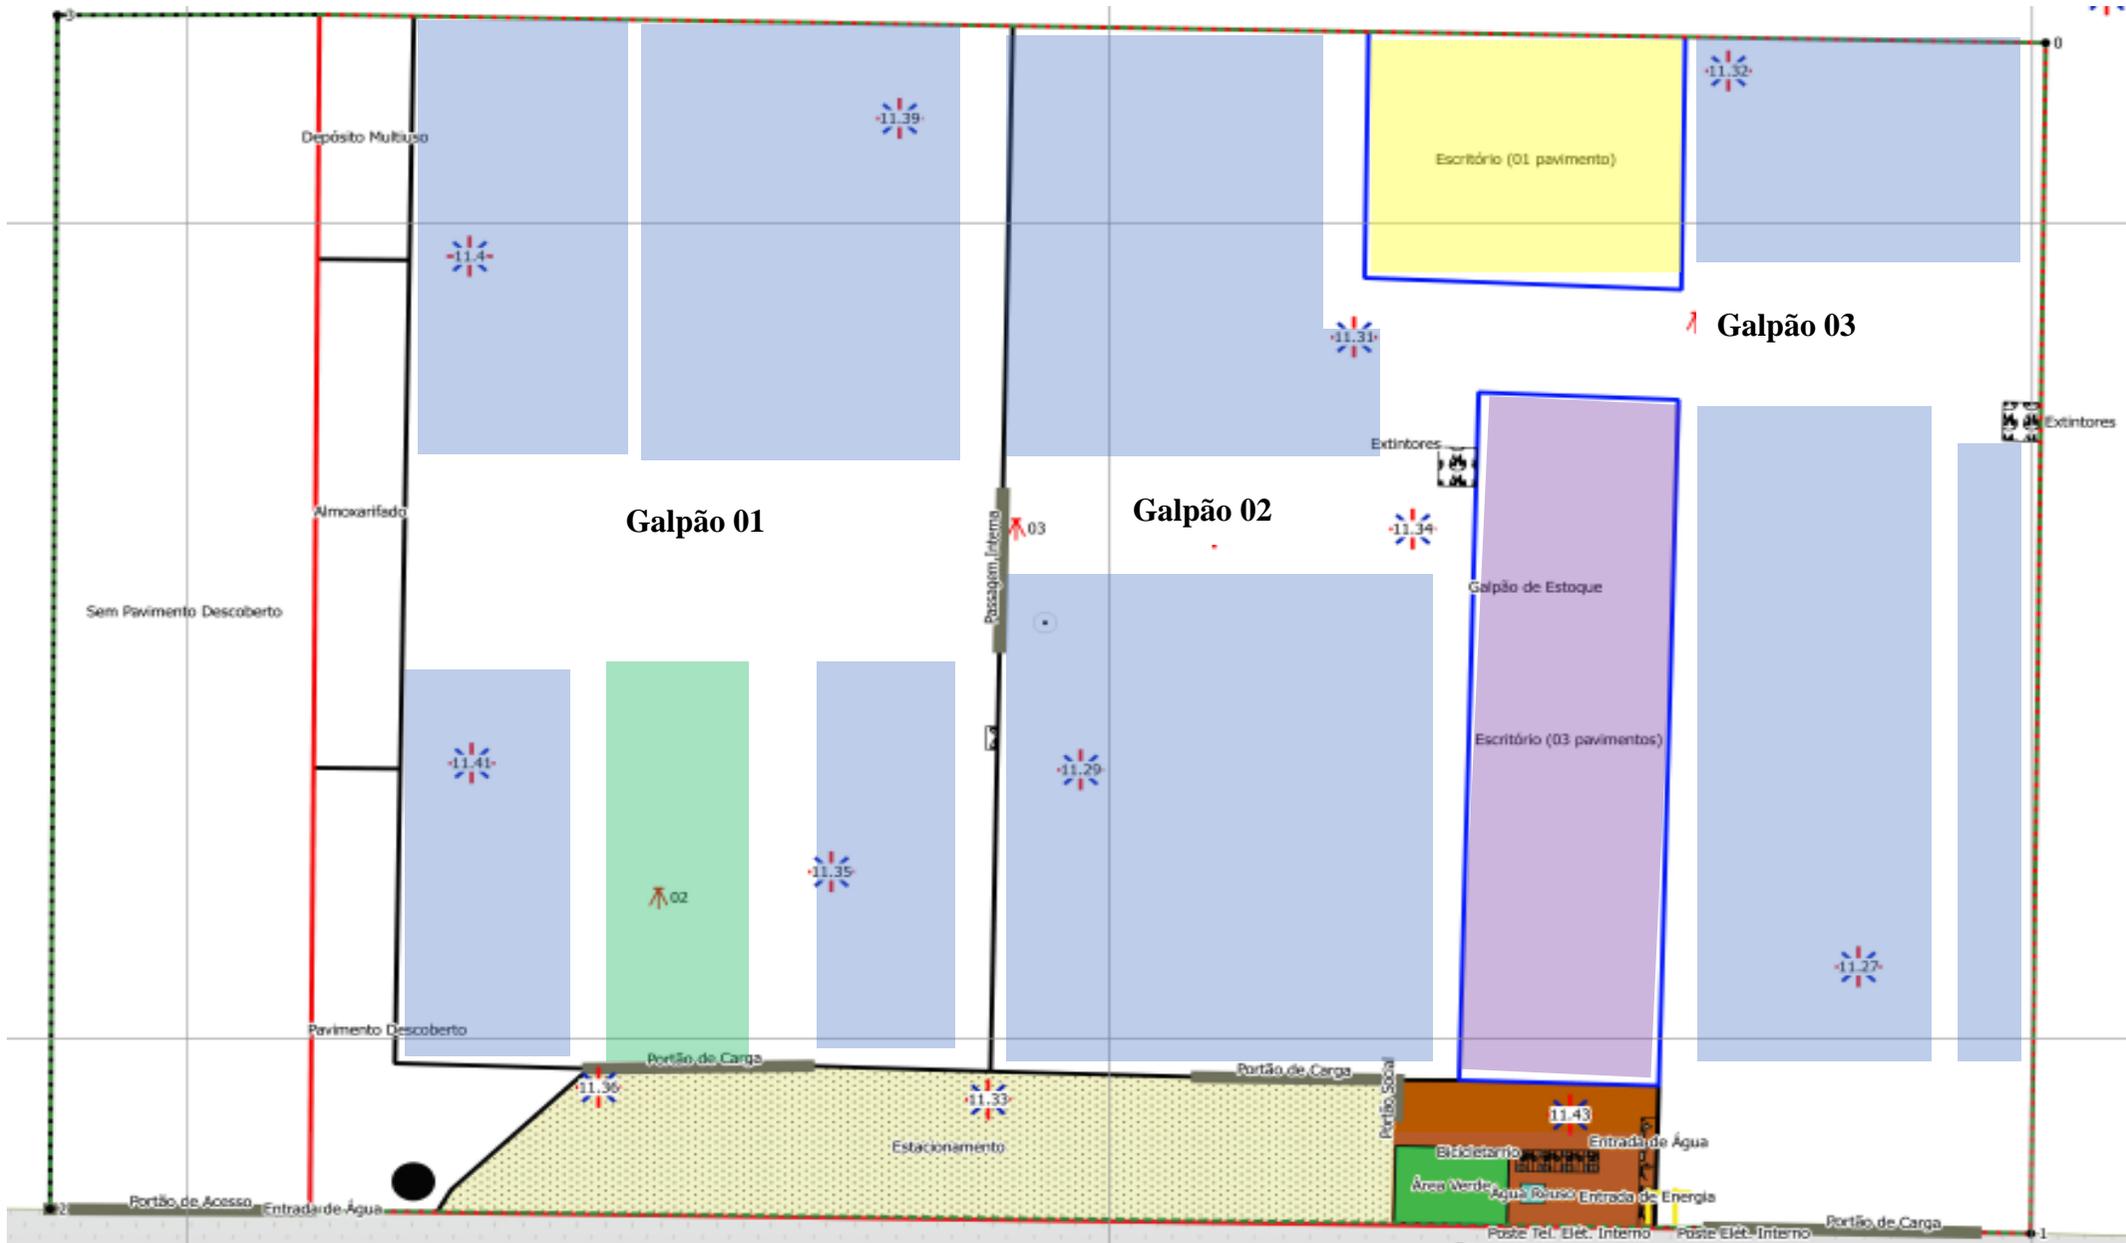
Planta Planialtimétrica Georreferenciada Cadastral
